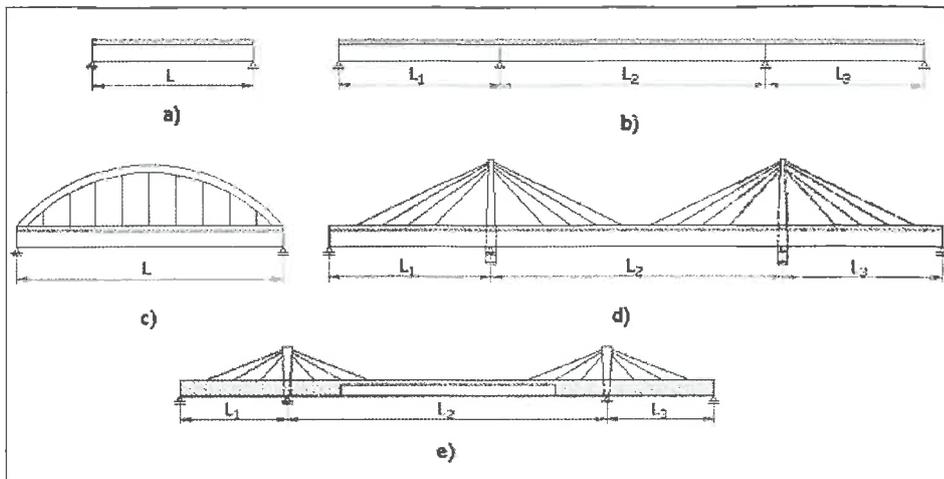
Scheme statice de structuri mixte cu conlucrare
